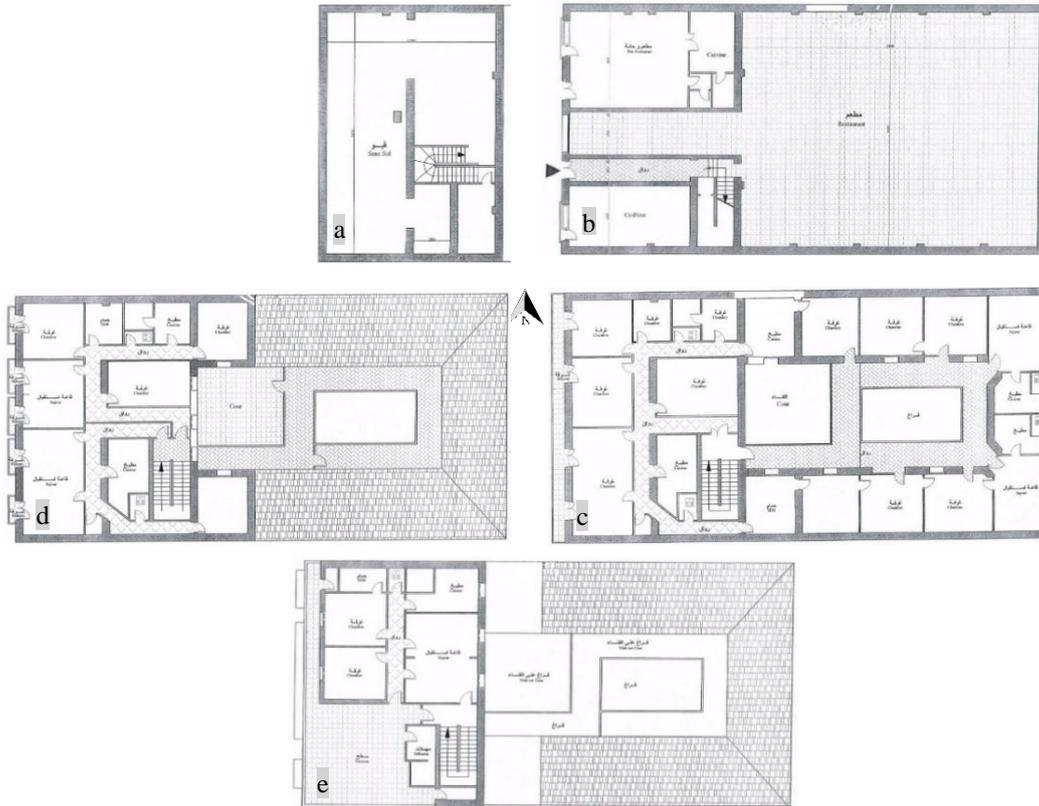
a) plan du sous-sol ; b) plan du rdc ; c) plan du R+1 ; d) plan du R+2 et R+ 3 ; (e) plan de toiture.( B.E.T Bouamama).
